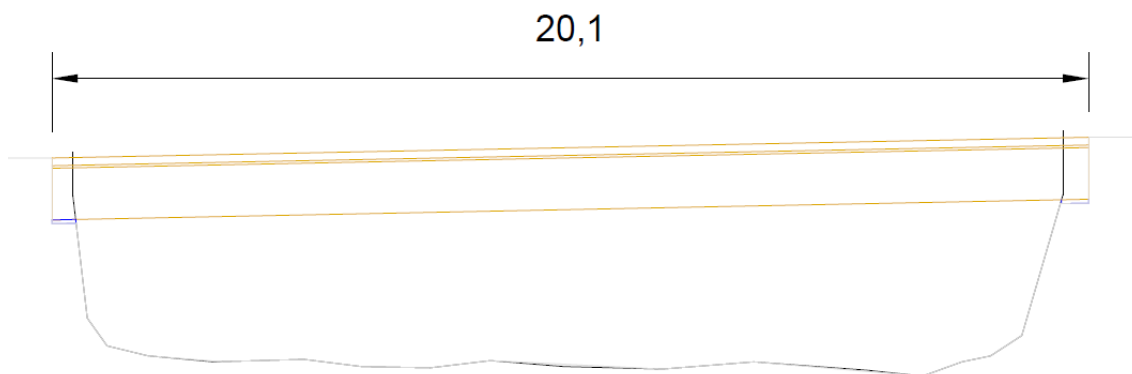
Sección longitudinal (viga) apoyada sobre neopreno zunchado sobre el terreno. Fuente: Propia.
